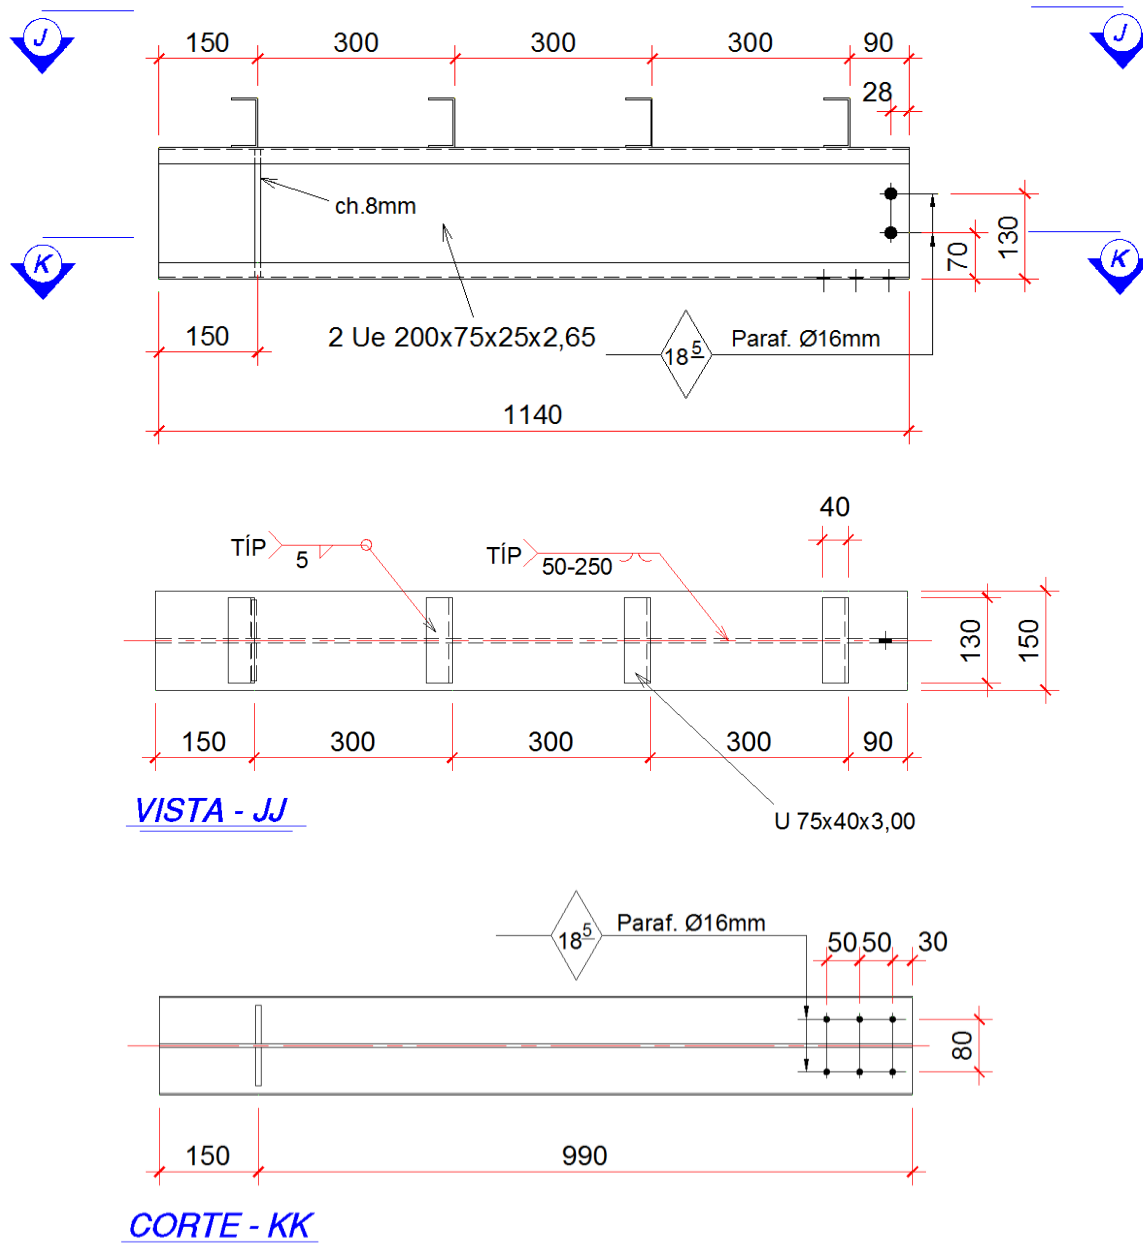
Detalhamento das vigas do modelo parafusado
